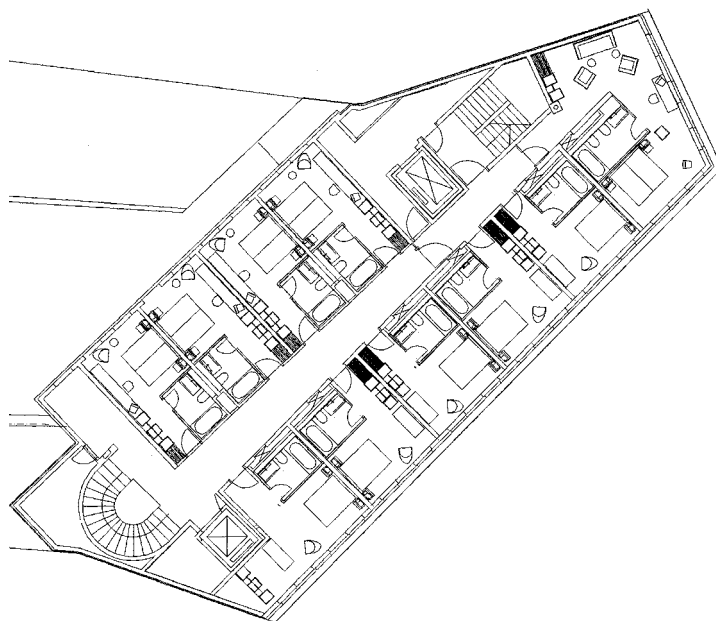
Grundriss © Peter Lorenz Ateliers
